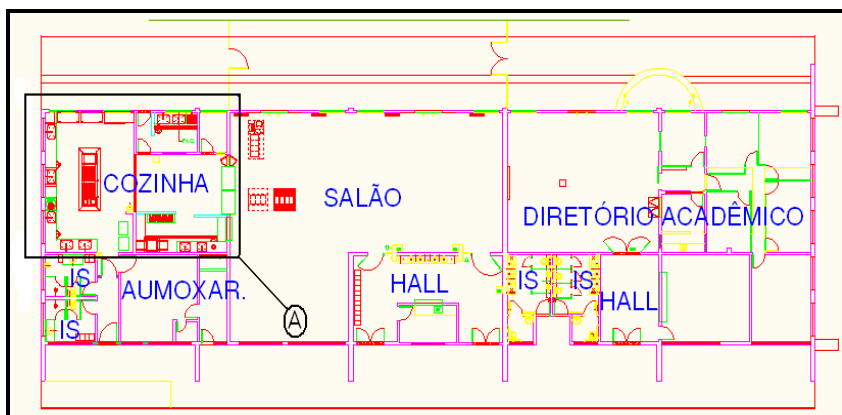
Planta geral do prédio 02 do Campus II - CEFET-MG
